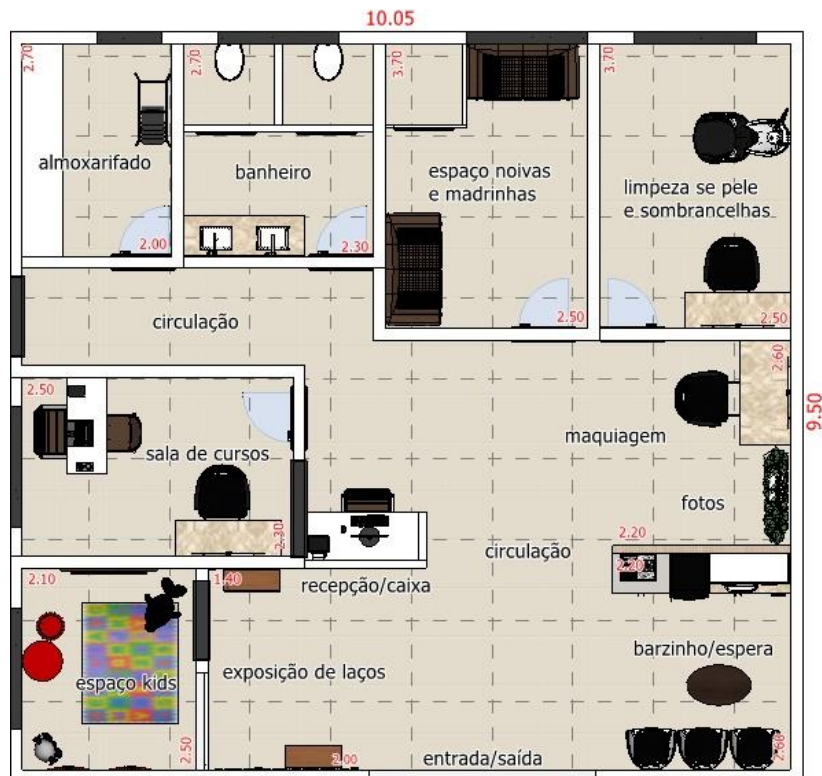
Planta baixa do escritório, vista superior – layout (arranjo físico)
